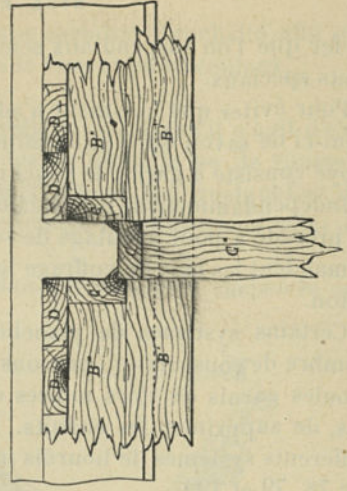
Coffrage pour un plancher à poutres, système HENNEBIQUE.
